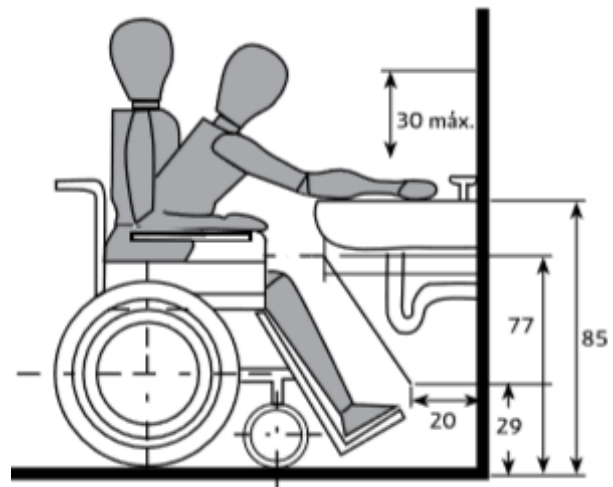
DIMENSIONES ACCESIBLES PARA LA COLOCACIÓN DEL LAVAMANOS.
